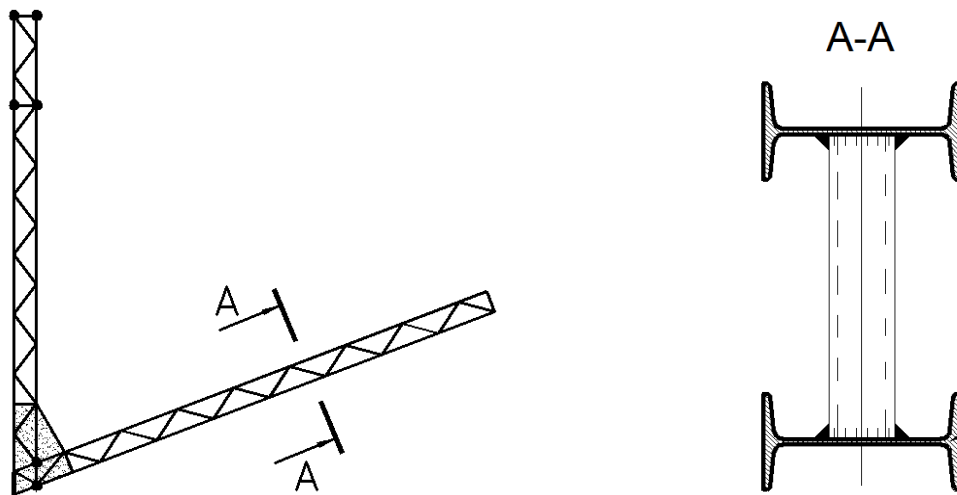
Схема Г-образной фермы декоративных элементов фасада.
